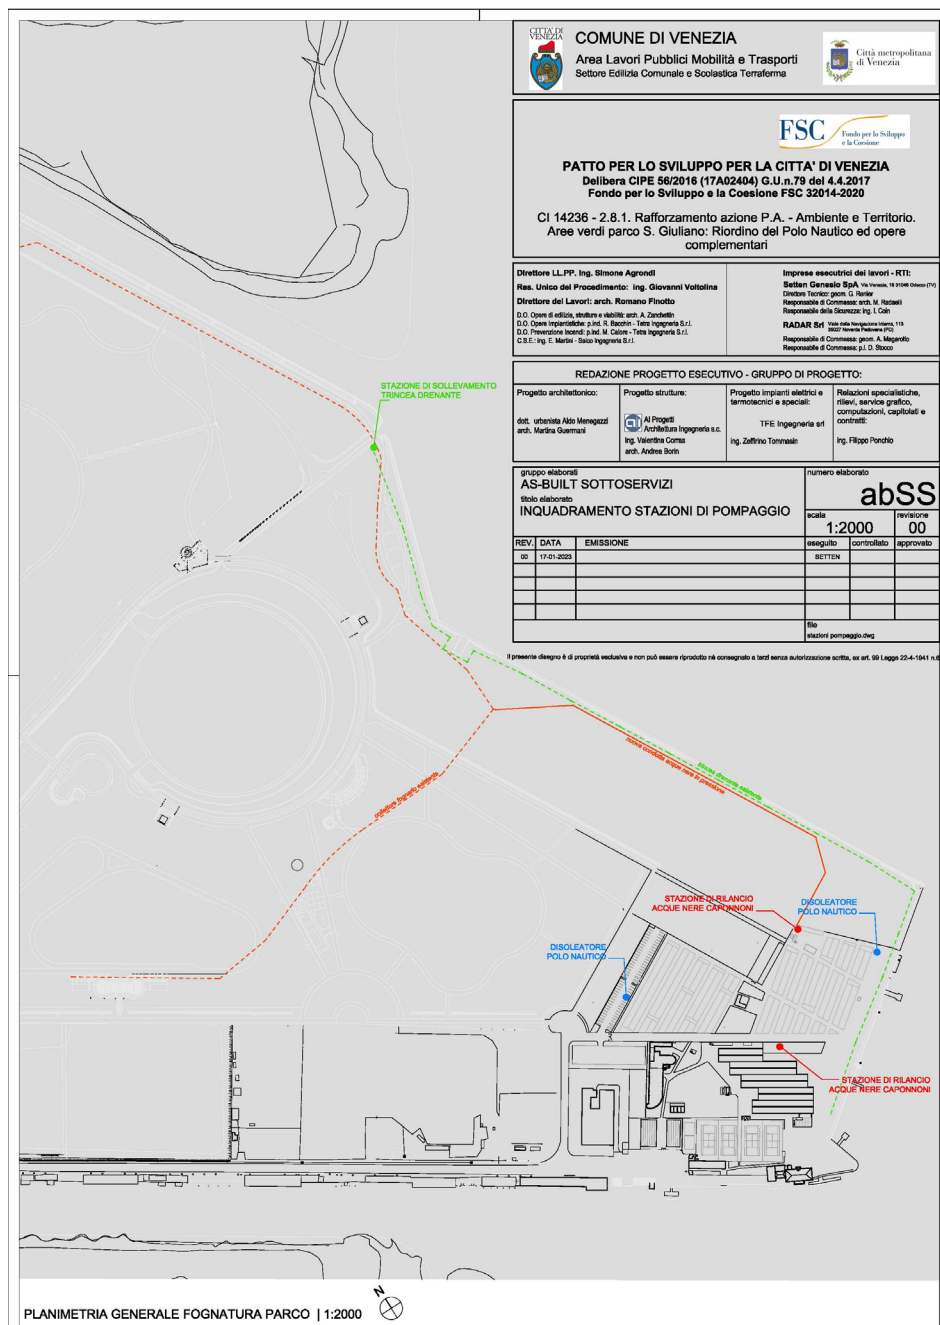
rete in pressione e impianto di sollevamento acque nere ed impianto di sollevamento condotta drenante con pozzetti di linea
